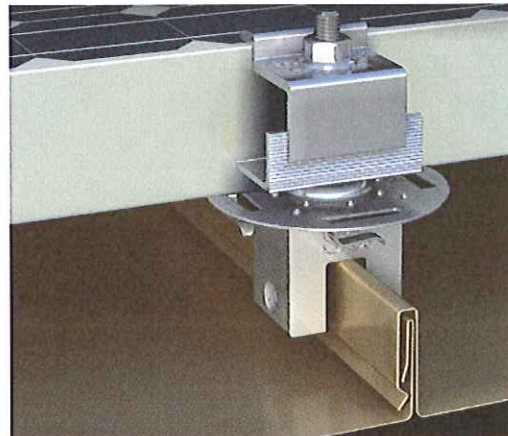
système de fixation pour pose sur couverture zinc à joints debout.
